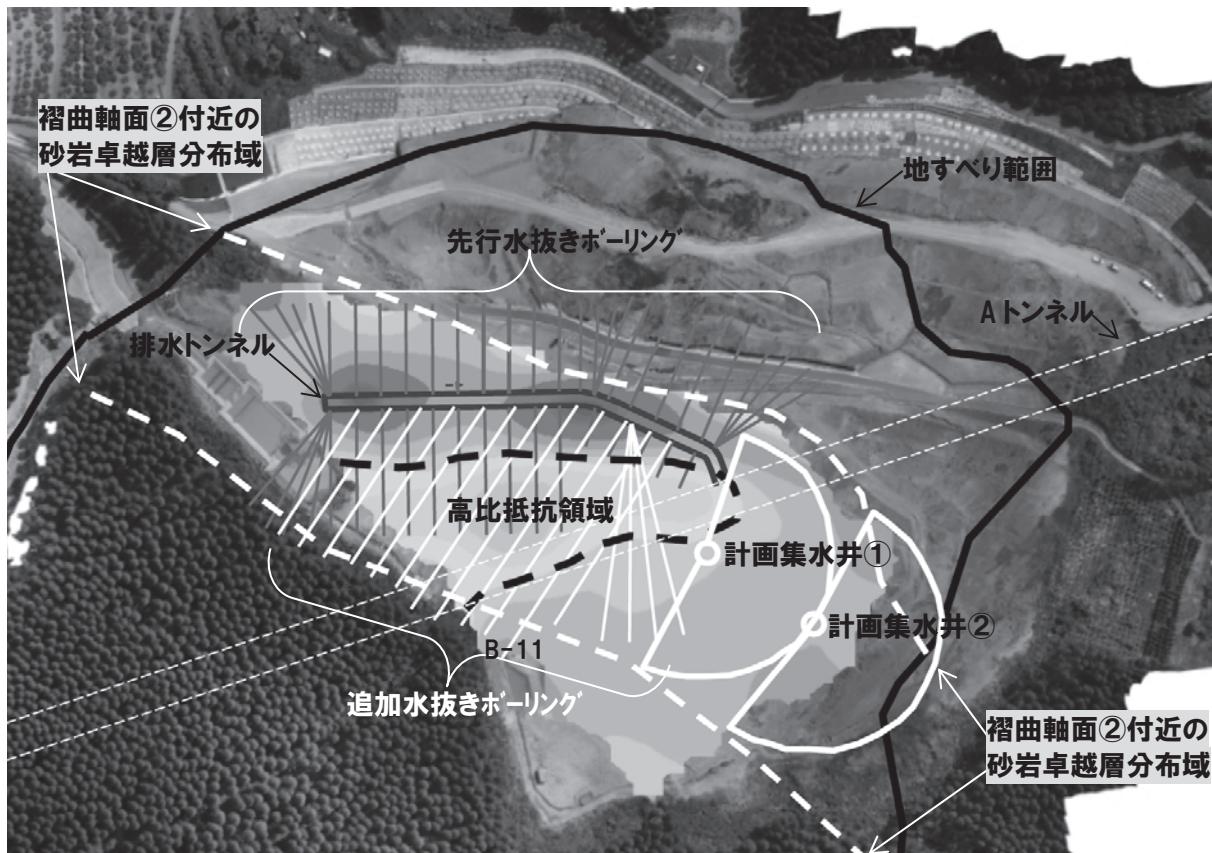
3 次元電気探査結果スライス平面図（施工後・標高 150m）及び集水井計画配置図
